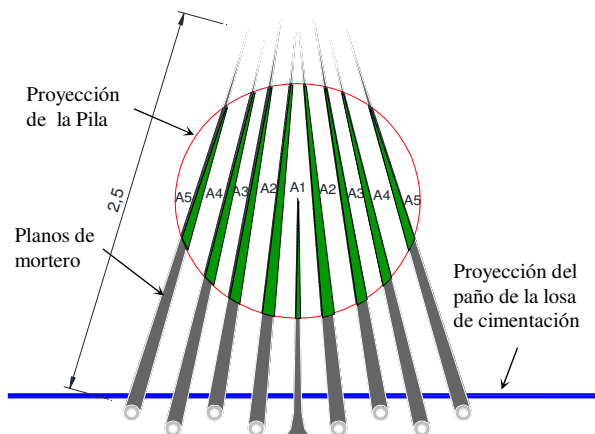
Arreglo de los planos de mortero bajo la proyección de la pila.
